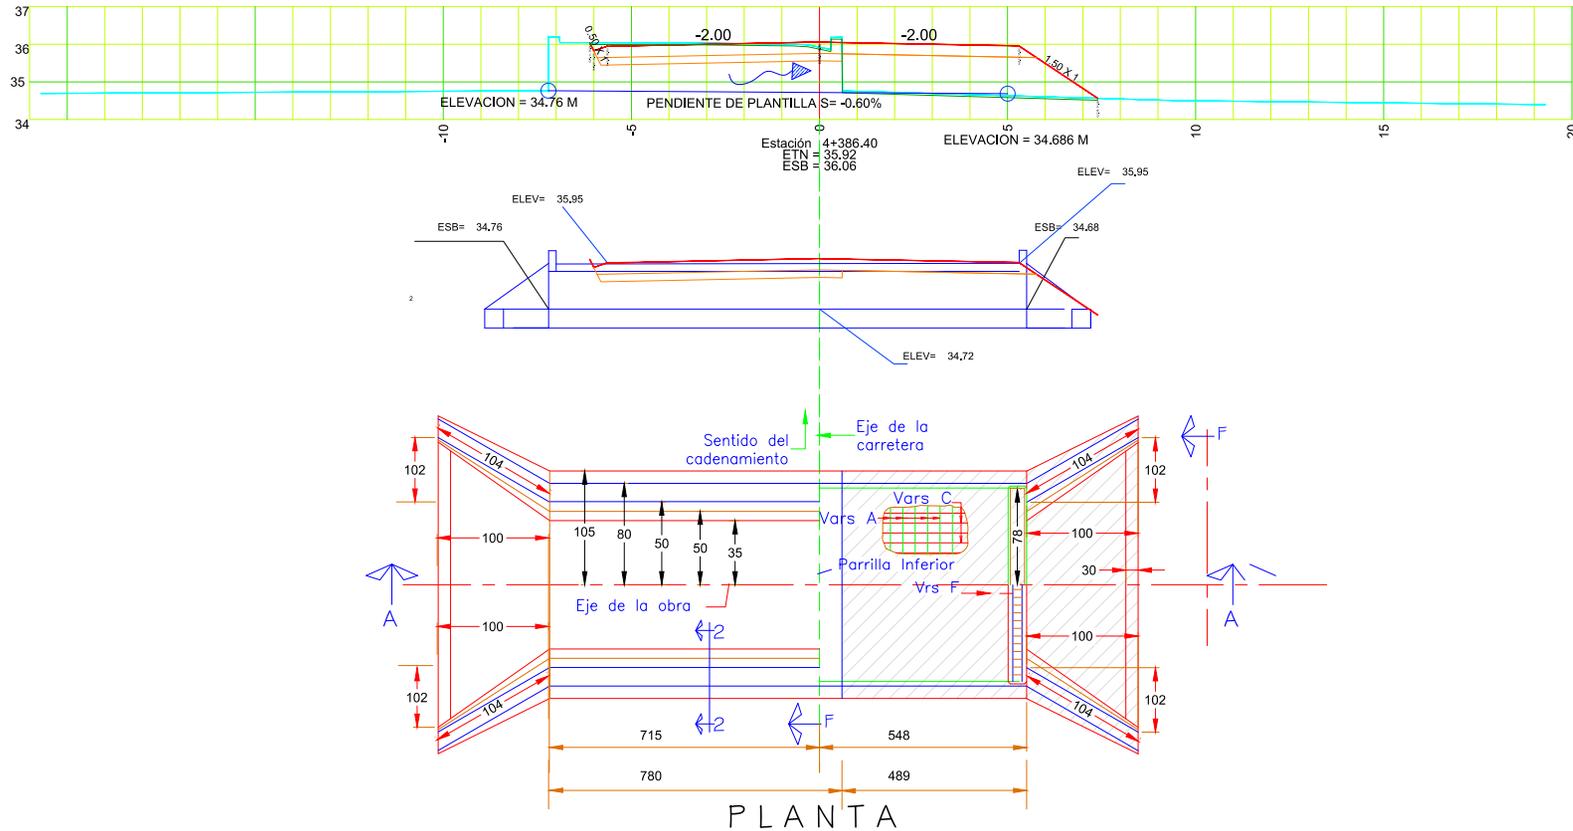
Sección estructural en planta para losas de 1 x 1 metros
